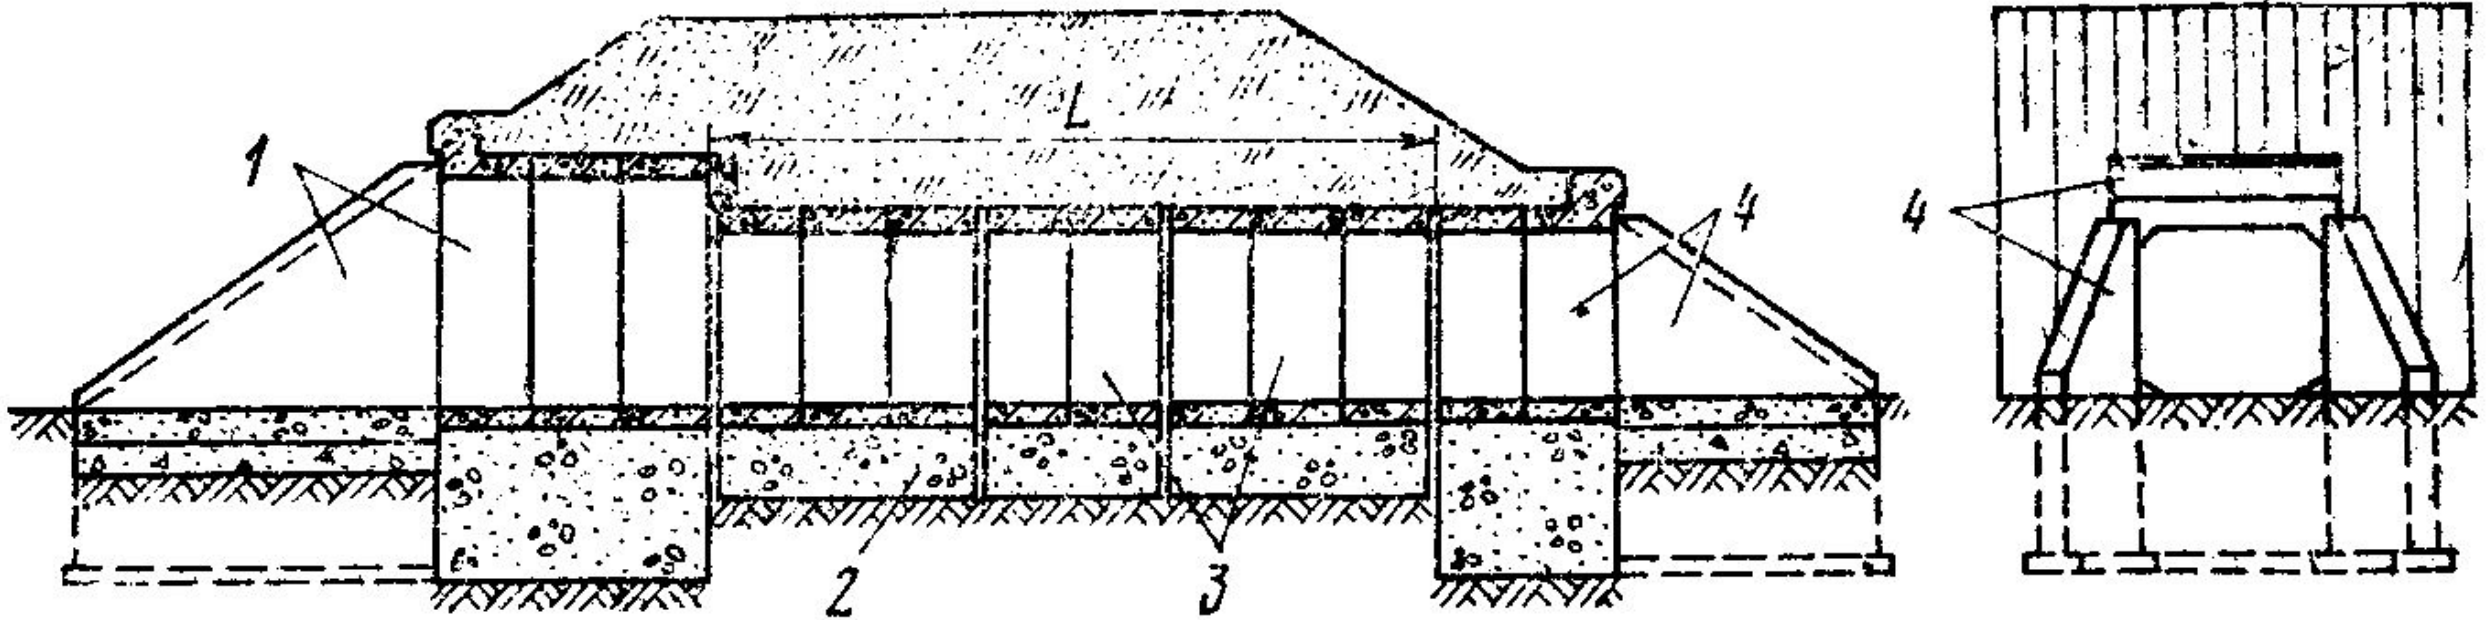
Конструктивная схема прямоугольной трубы: 1 – входной оголовок; 2 – фундамент; 3 – звено трубы; 4 – выходной оголовок
